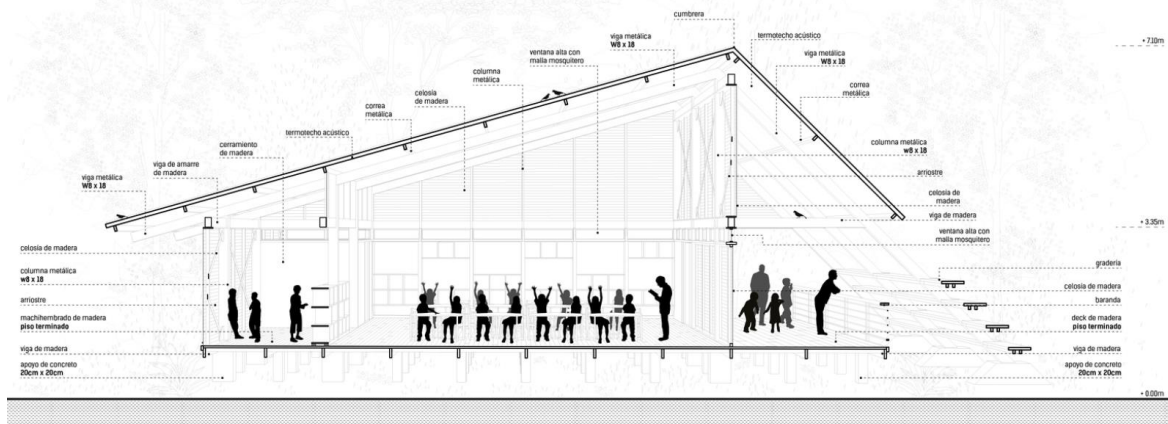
Corte de módulo prefabricado -Plan Selva Infraestructura Escuela N°601453
